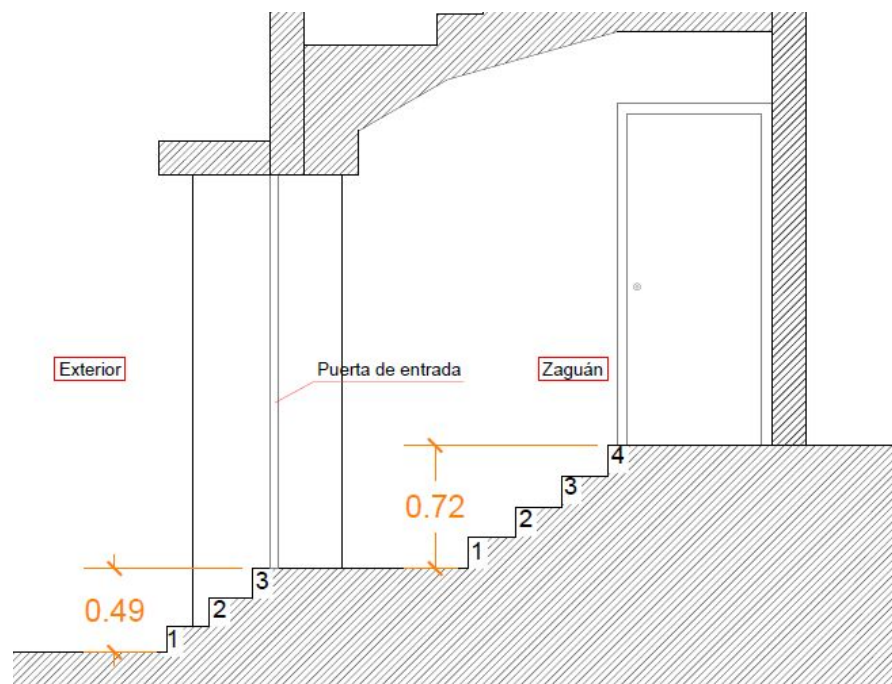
Sección entrada, BH E5 (Fuente: Anejo A)
